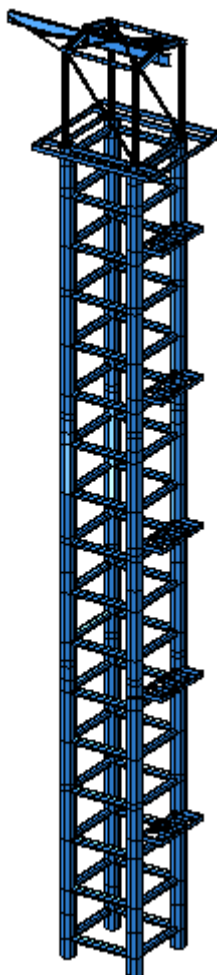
Общий вид расчетной схемы для расчета стальных конструкций
